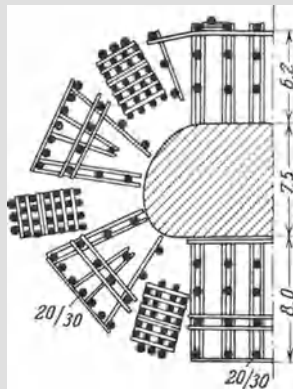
Landungsgehöft Cuxhaven, Schnitt durch den Kopf in Höhe der unteren Zangen. Maßstab 1 : 500.
